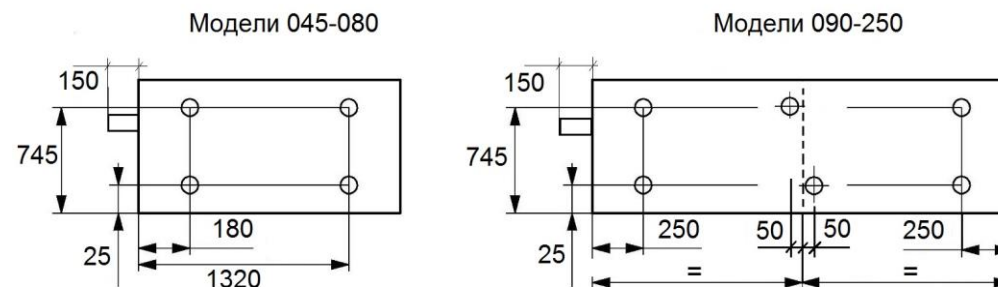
Схема крепления виброизоляторов к чиллеру (вид сверху).
